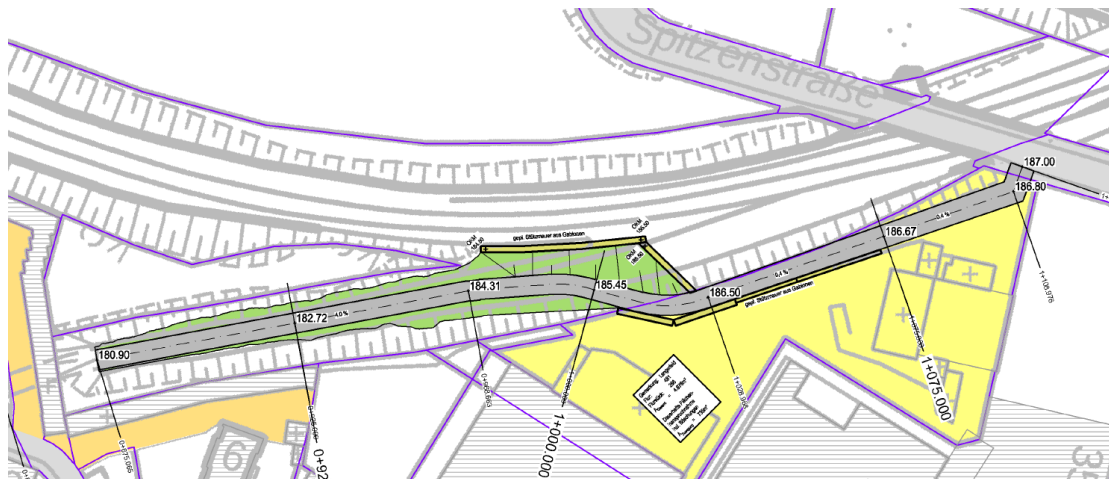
Lageplan der nördlichen Teilstrecke des Radweges
